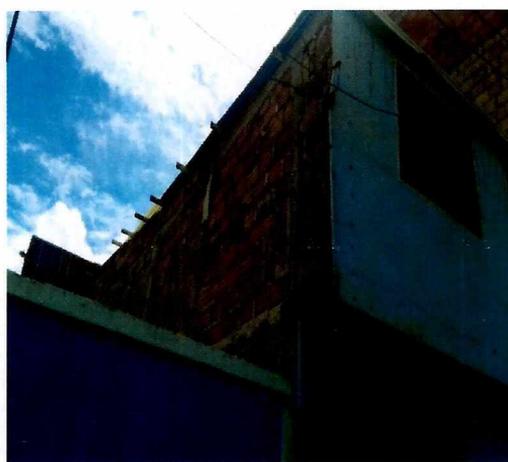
Pega y Ladrillos de Mampostería de Deficiente Calidad en el Predio 2 de la Manzana 4.
